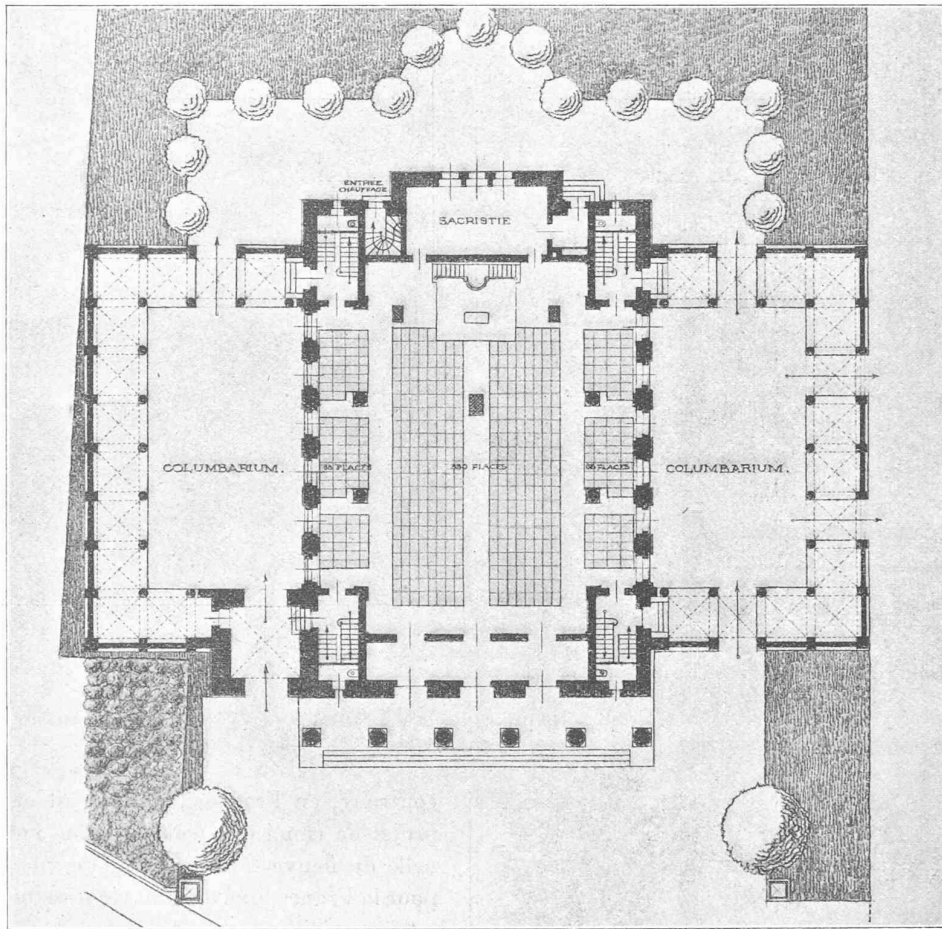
Plan du rez-de-chaussée. — 1 : 400.
